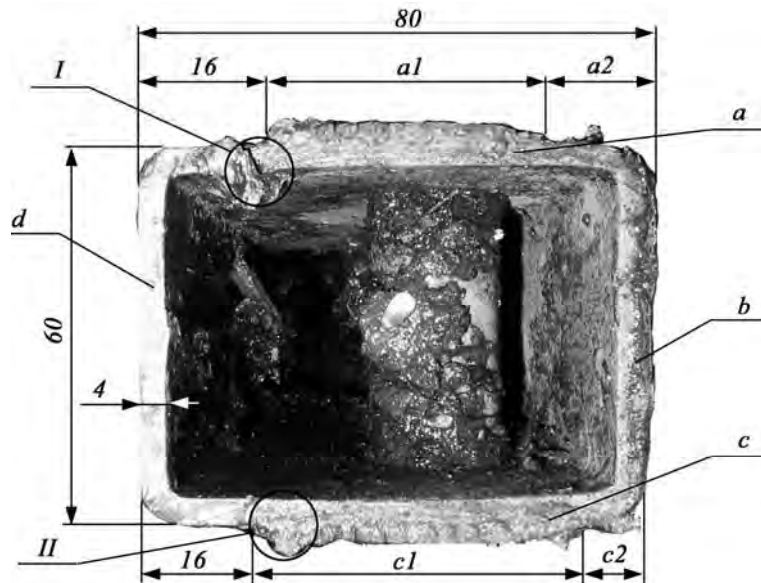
Вид сварных швов на стойке в плоскости разрушения
